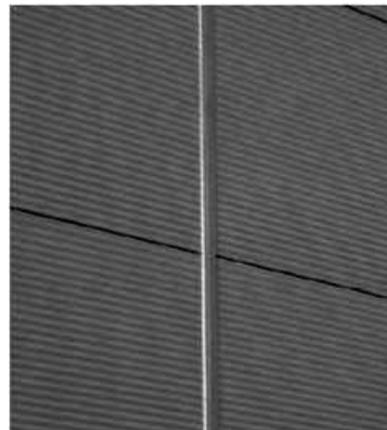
Perfis de acabamento instalado na junta vertical entre painéis adjacentes. (DÂNICA, 2013b)
